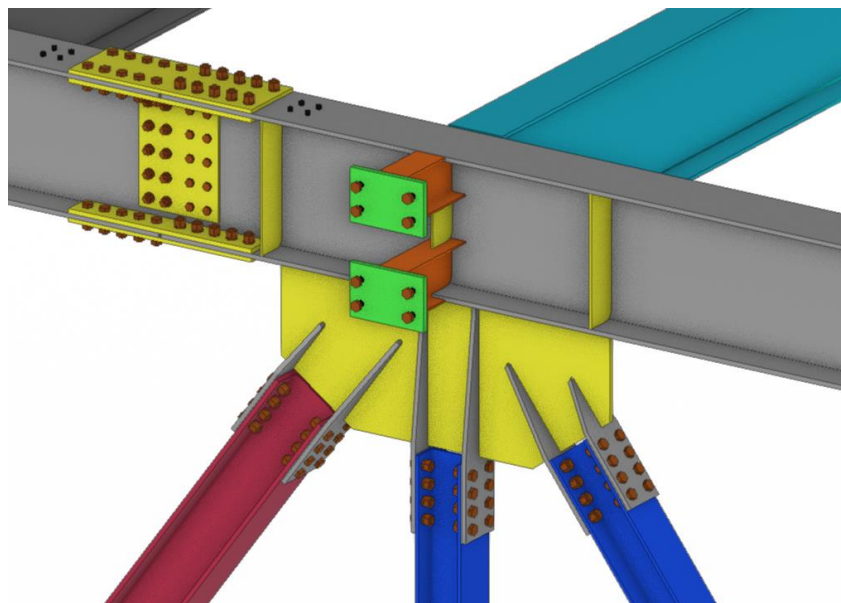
Vista de modelo BIM para el desarrollo de la ingeniería de detalle
